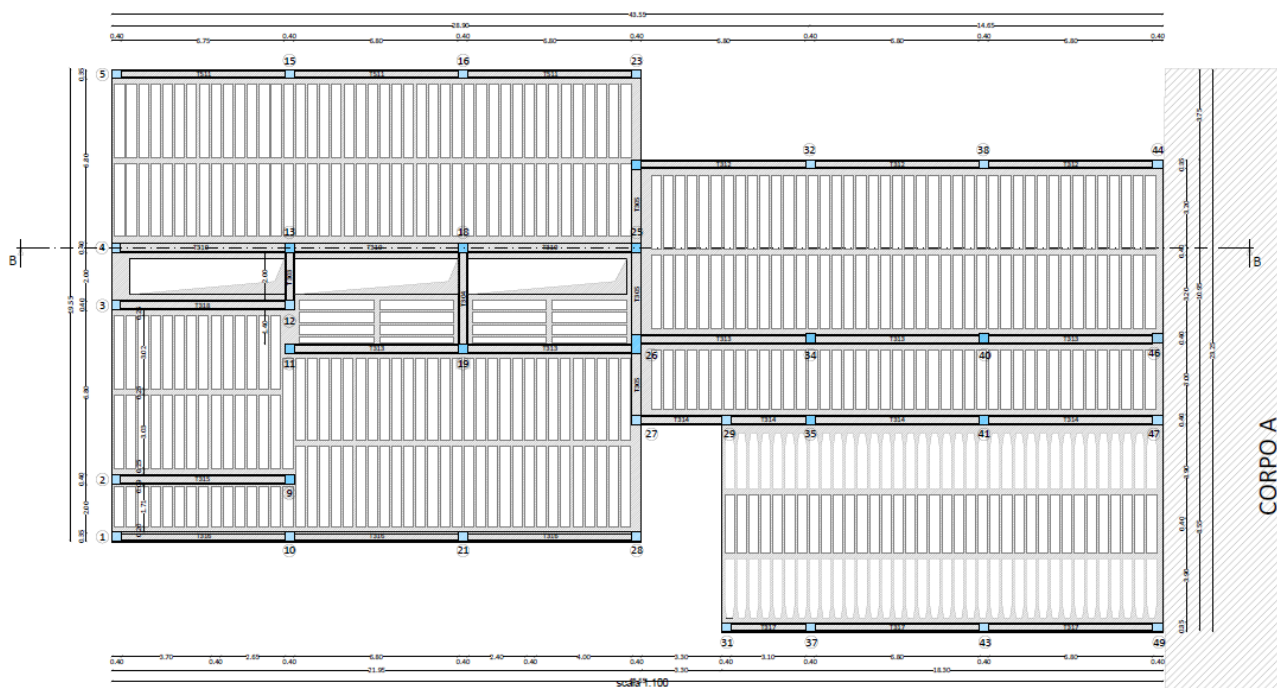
, Blocco B-Planimetria Struttura del Piano Copertura.
